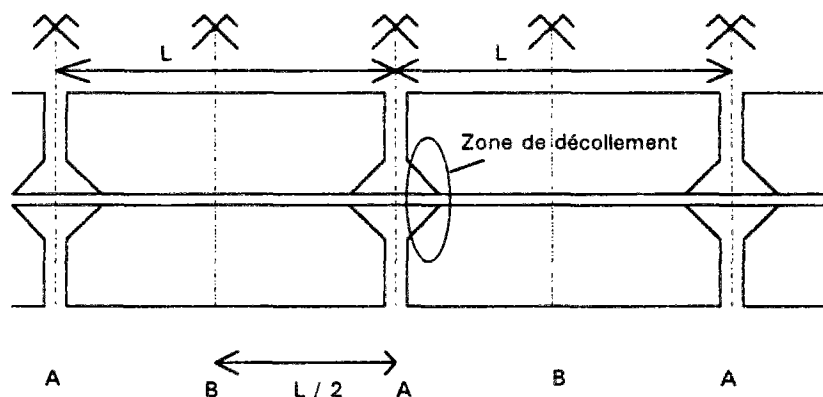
Schéma de fissuration d'une chaussée en BAC
